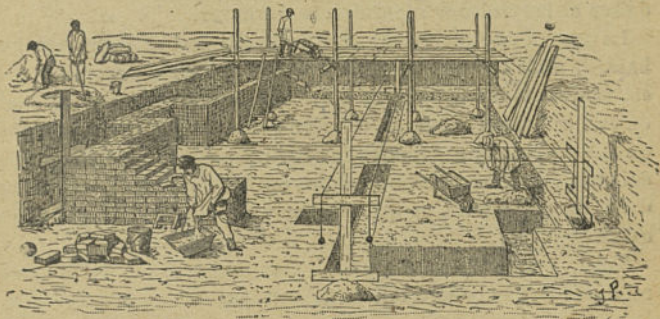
Chantier de construction; les murs commencent à s'élever.
